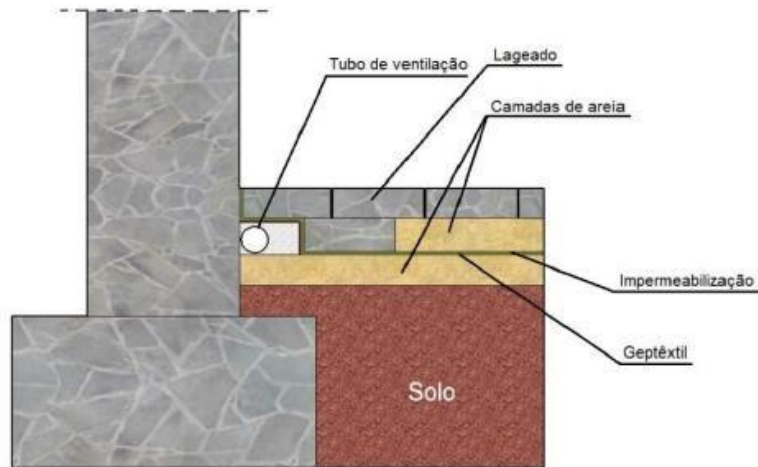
Corte construtivo do sistema de ventilação interior localizado na base da parede [13]
